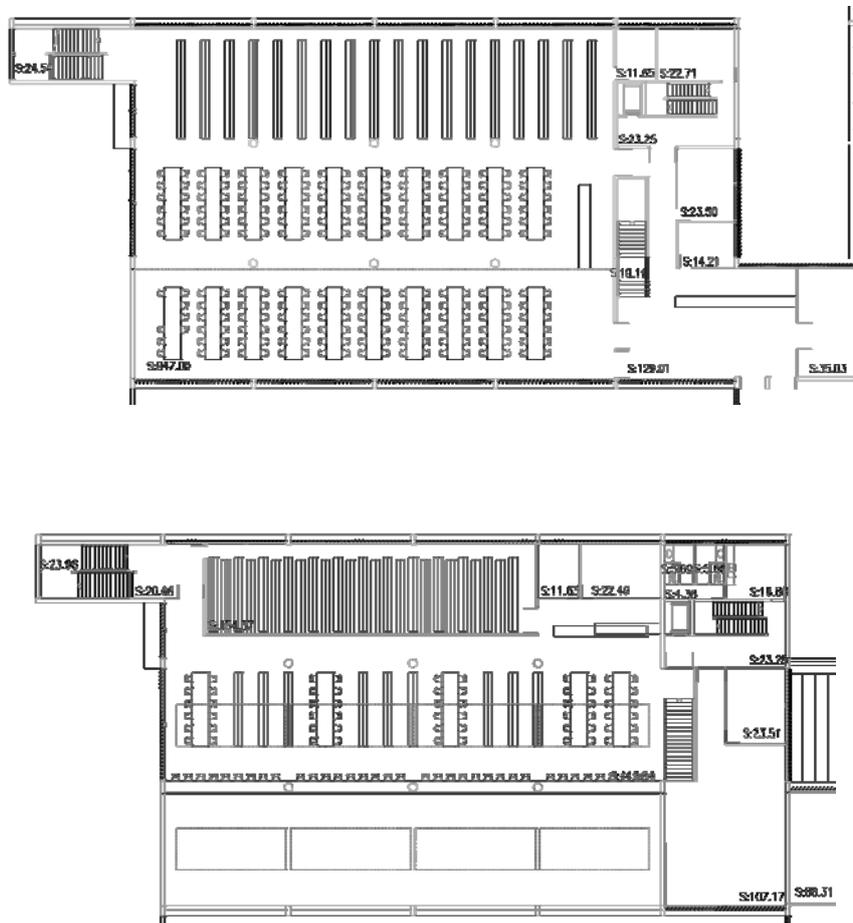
Localización y distribución de la biblioteca Hypatia de Alejandría en planta primera (imagen superior) y segunda (imagen inferior)
